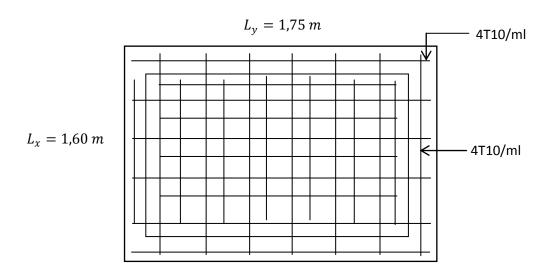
Ferraillage inférieur de la dalle de l'ascenseur
